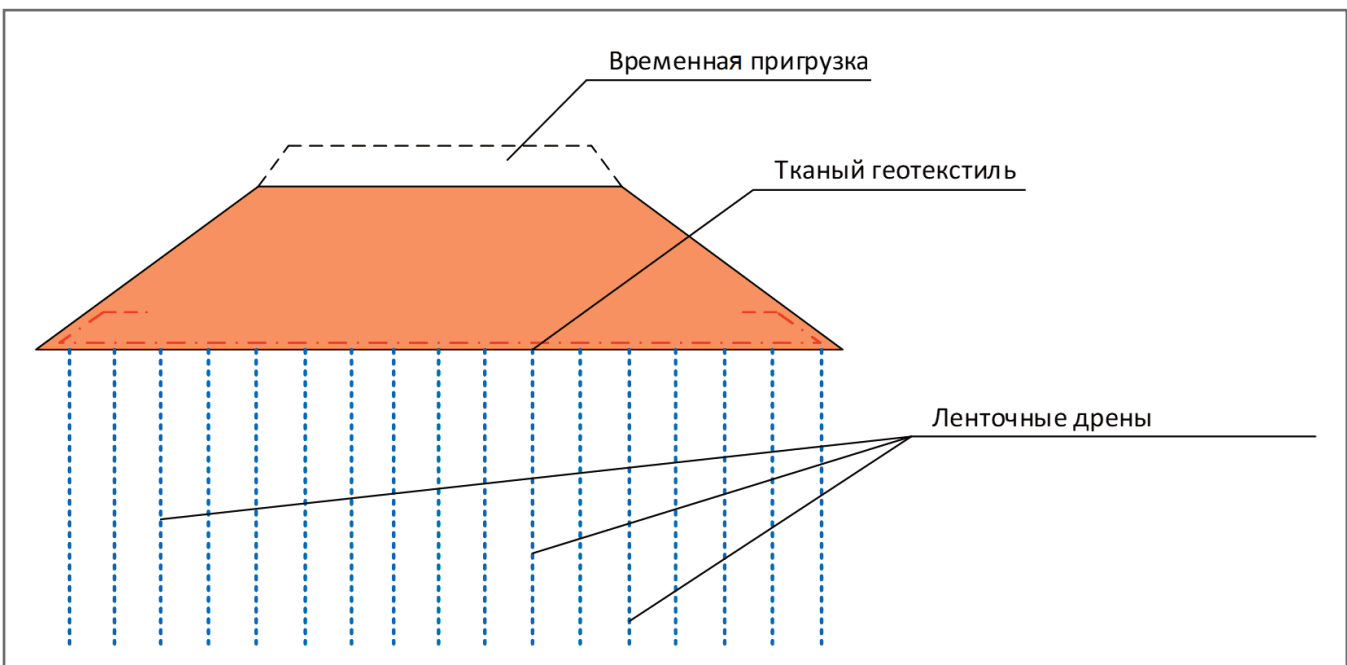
Комбинированное решение. Схема армированной насыпи с ленточными дренами в основании и временной пригрузкой в поперечном разрезе
